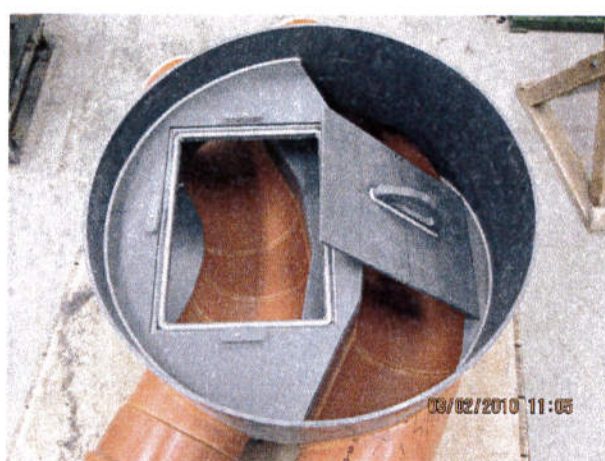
Fondo prefabbricato in PVC doppia tubazione
